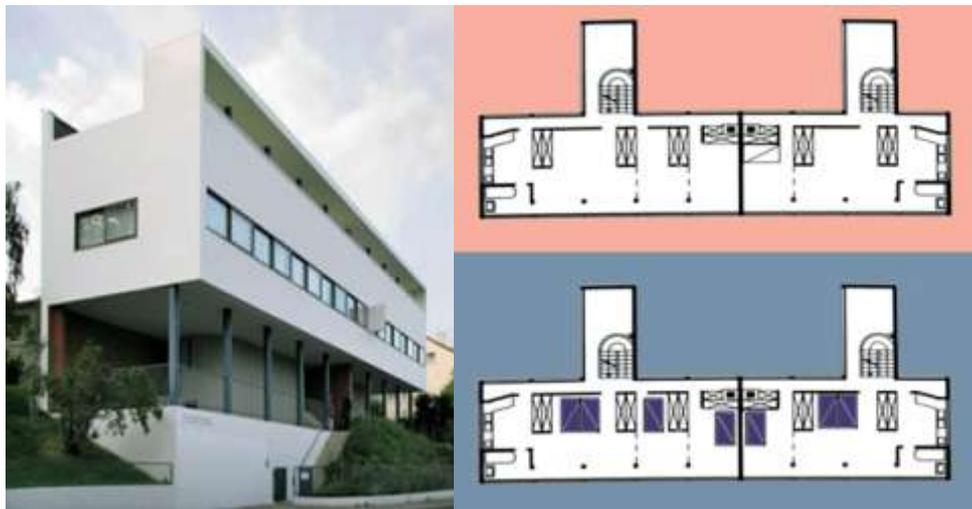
a) Bloco de apartamentos Weissenhofsiedlung (Disponível em: www.vitruvius.com); b) Planta do piso da casa geminada. A planta de cima apresenta a configuração diurna, a de baixo a configuração noturna. (adaptada de COHEN, 2006).
